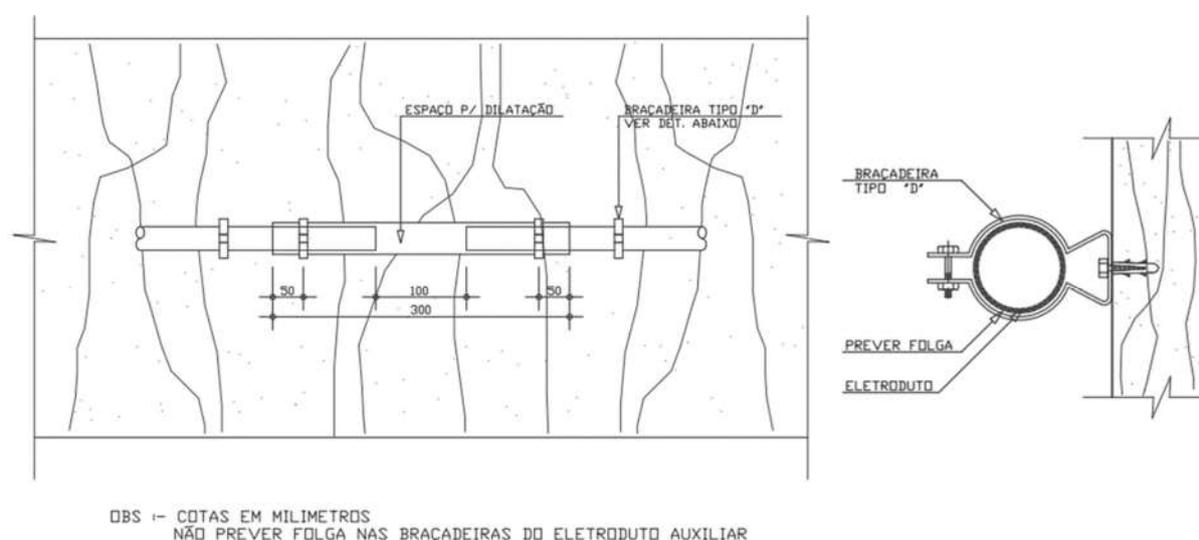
Emenda de eletrodutos de PVC em instalações externas
